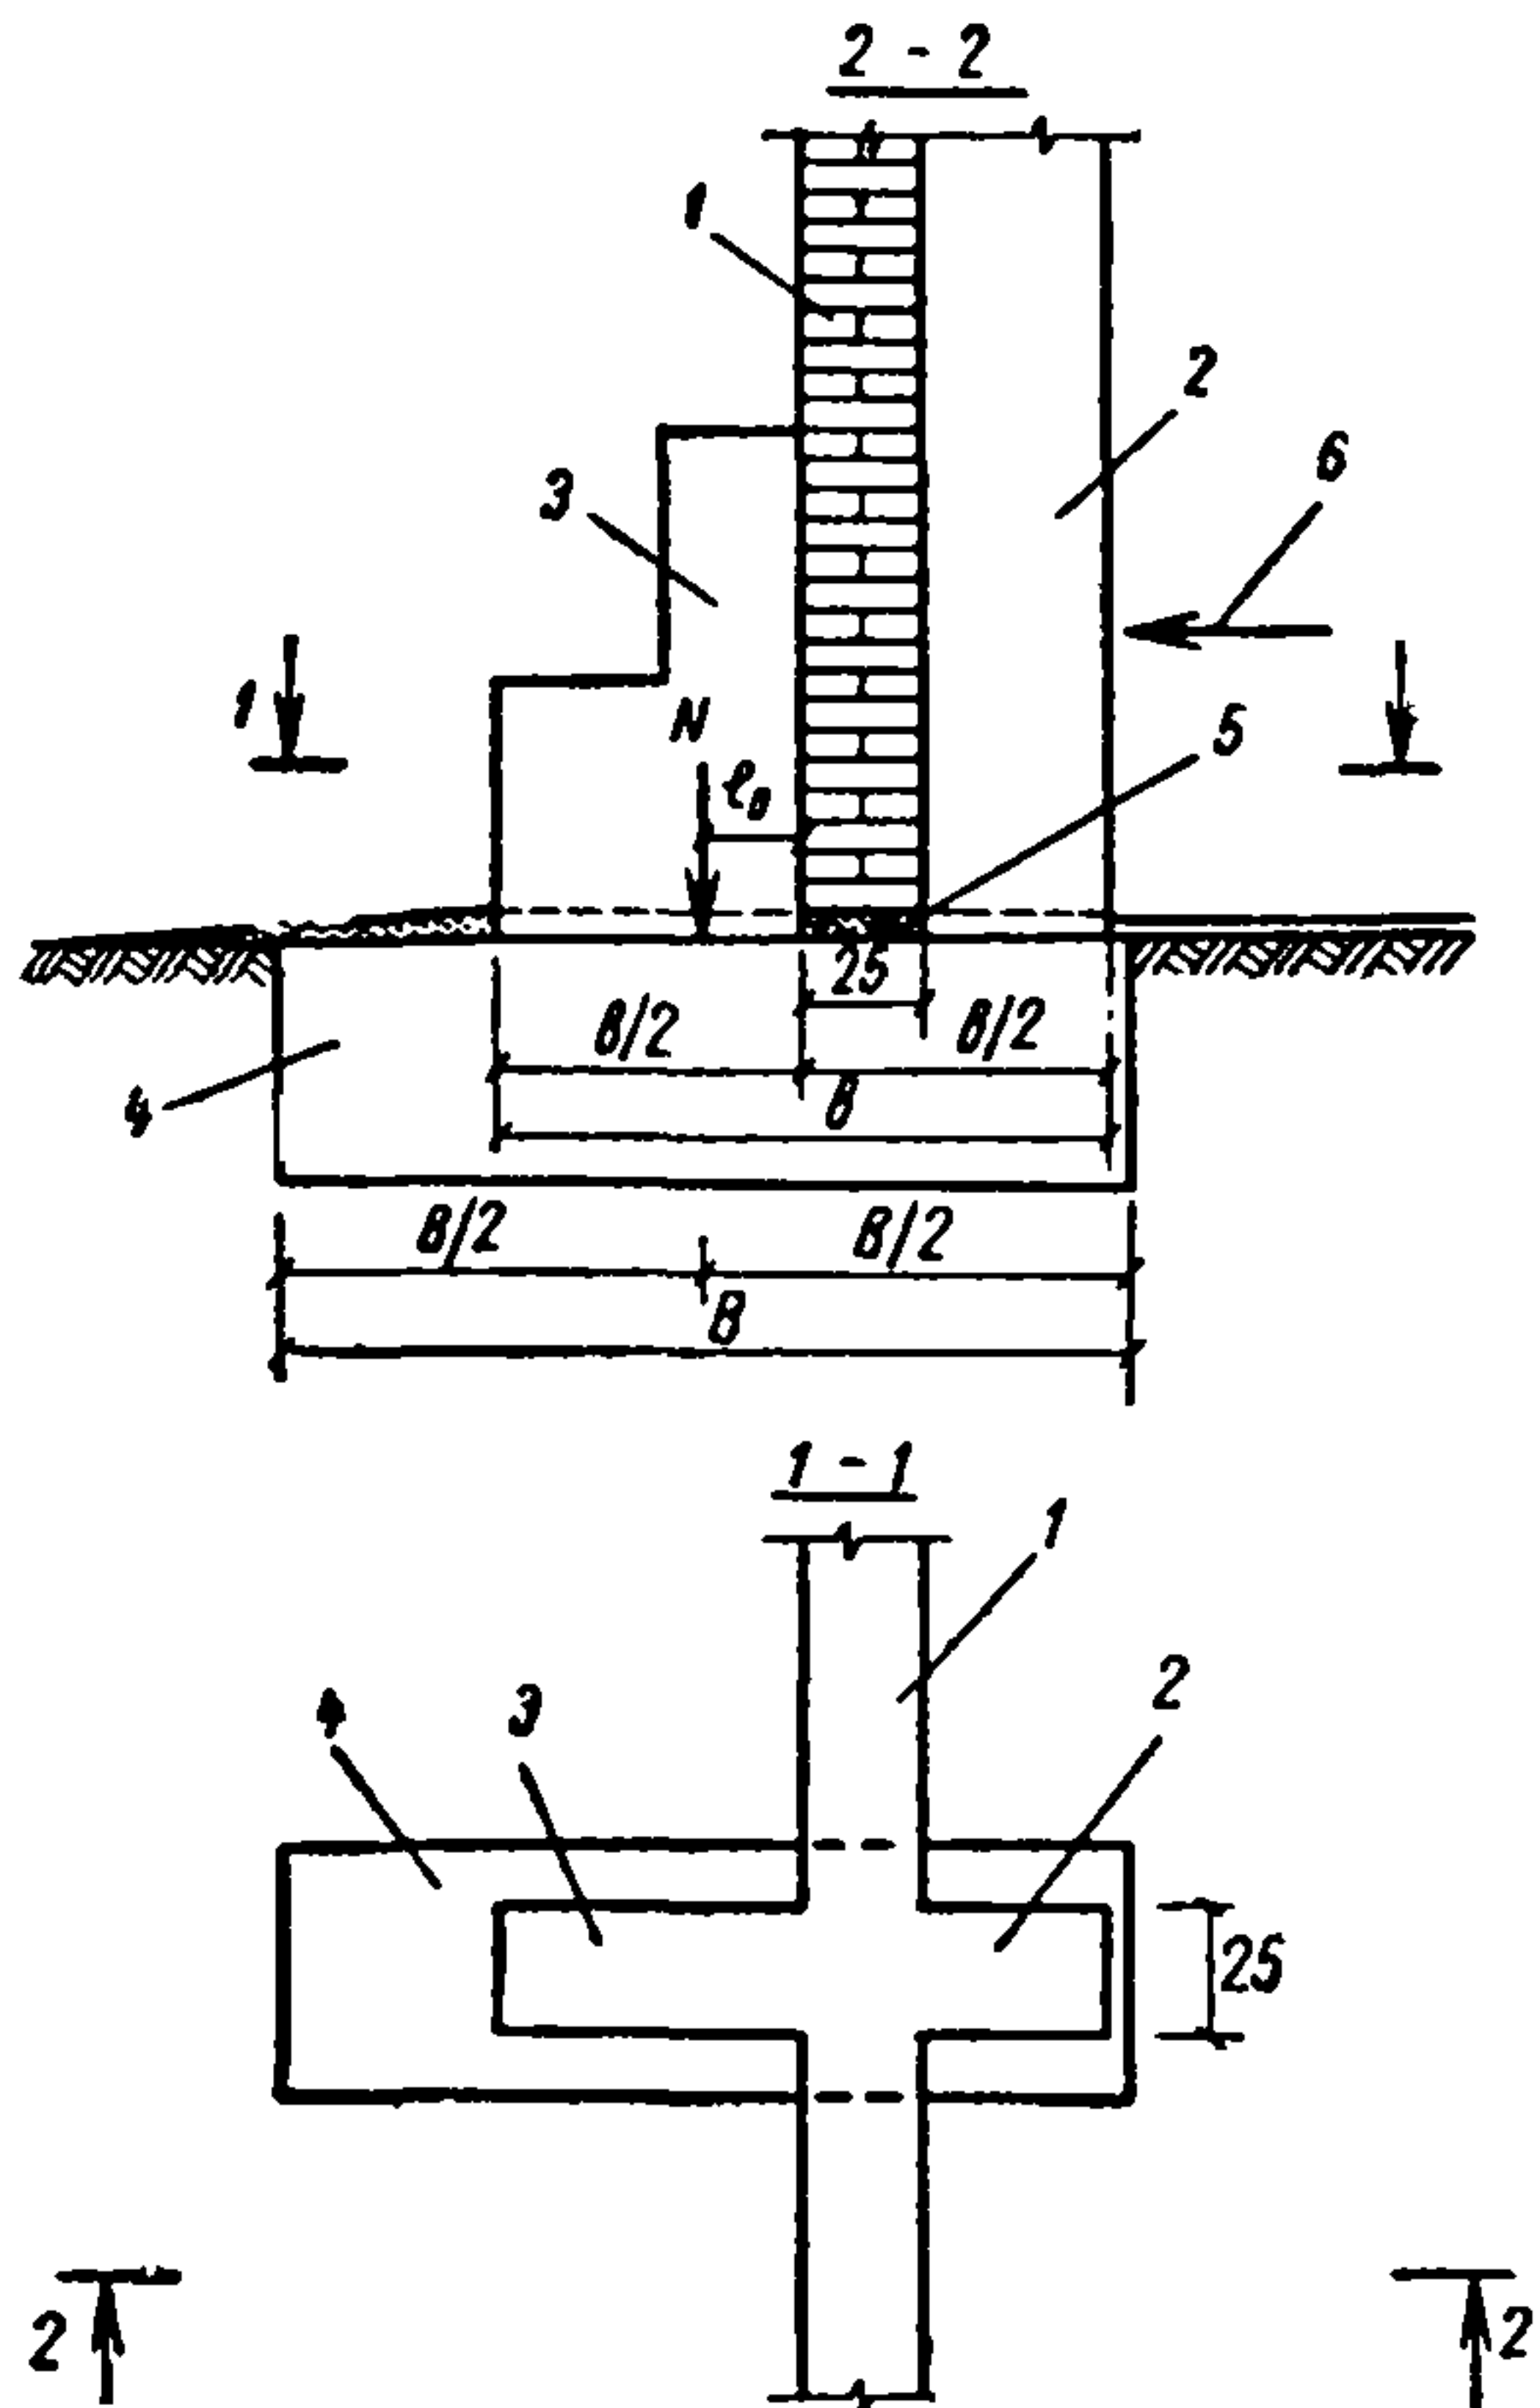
Фундаменты под наружными стенами одноэтажных складских зданий для сыпучих материалов
